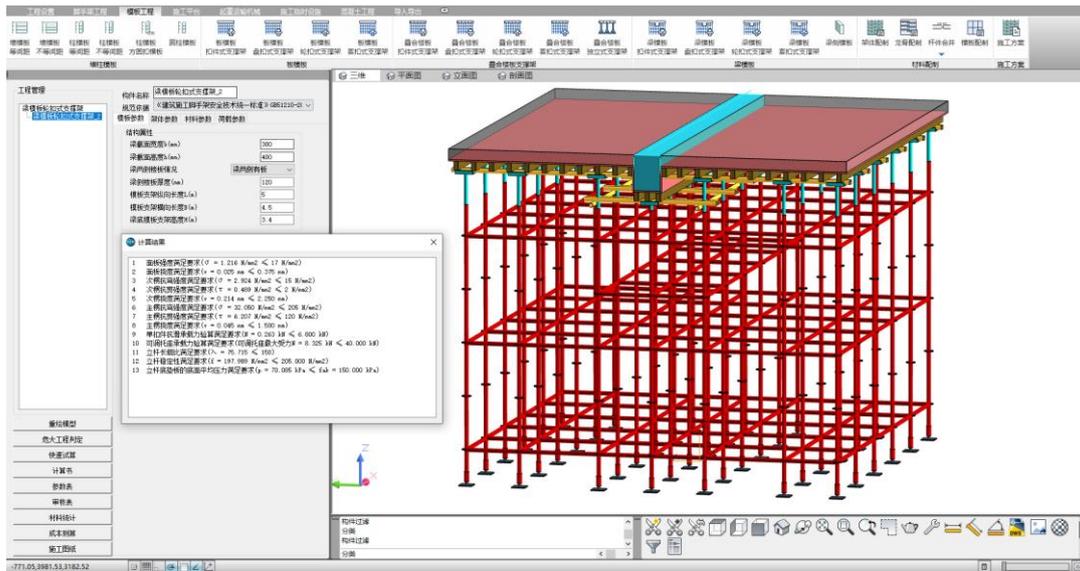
梁模板-轮扣式支撑架架体平面图
